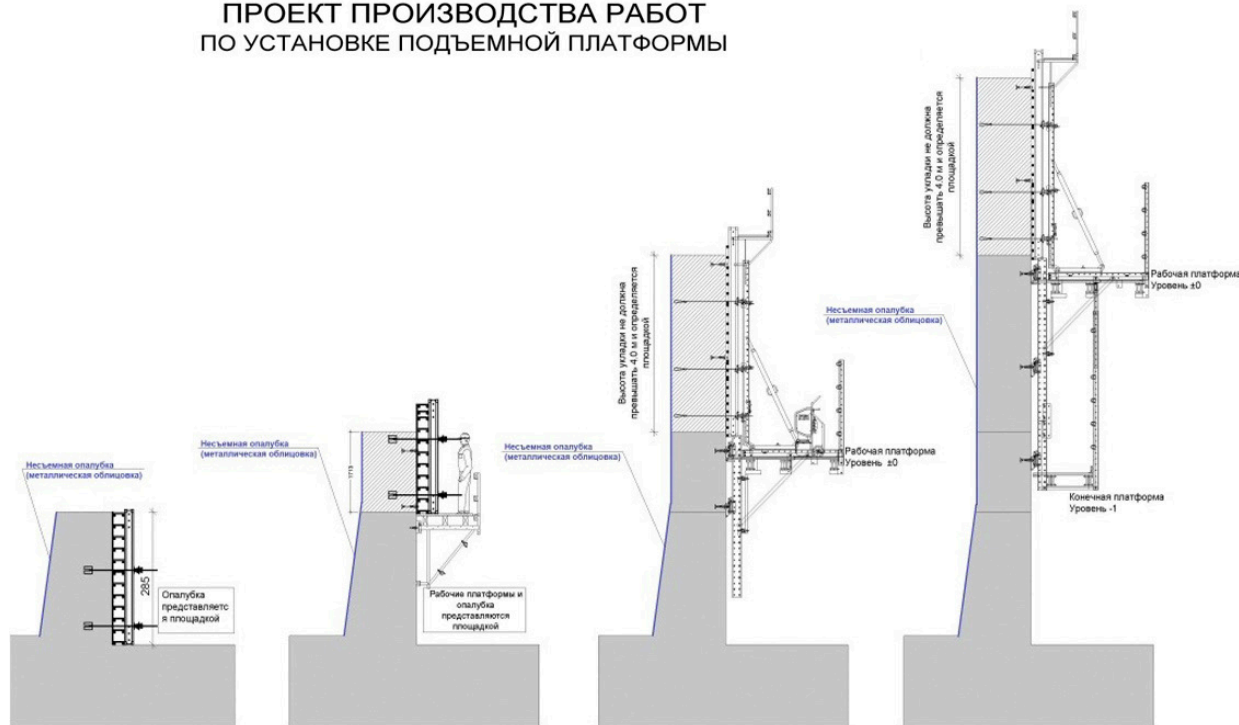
Схема работ по устройству самоподъемной опалубки фирмы Peri на АЭС «Аккую» для работ на ВЗО
